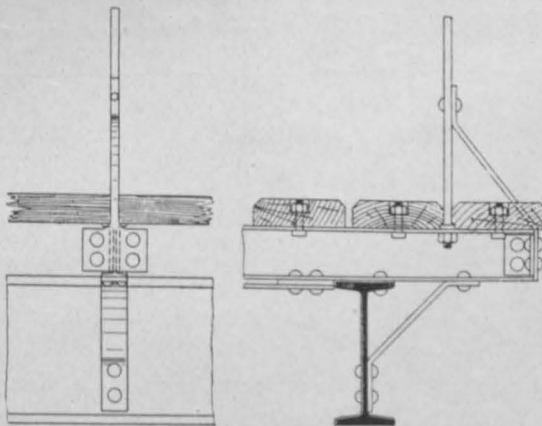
Fußgängerbrücken mit einfachem Bohlenbelage. Offene Fahrbahnen. 1:15.
